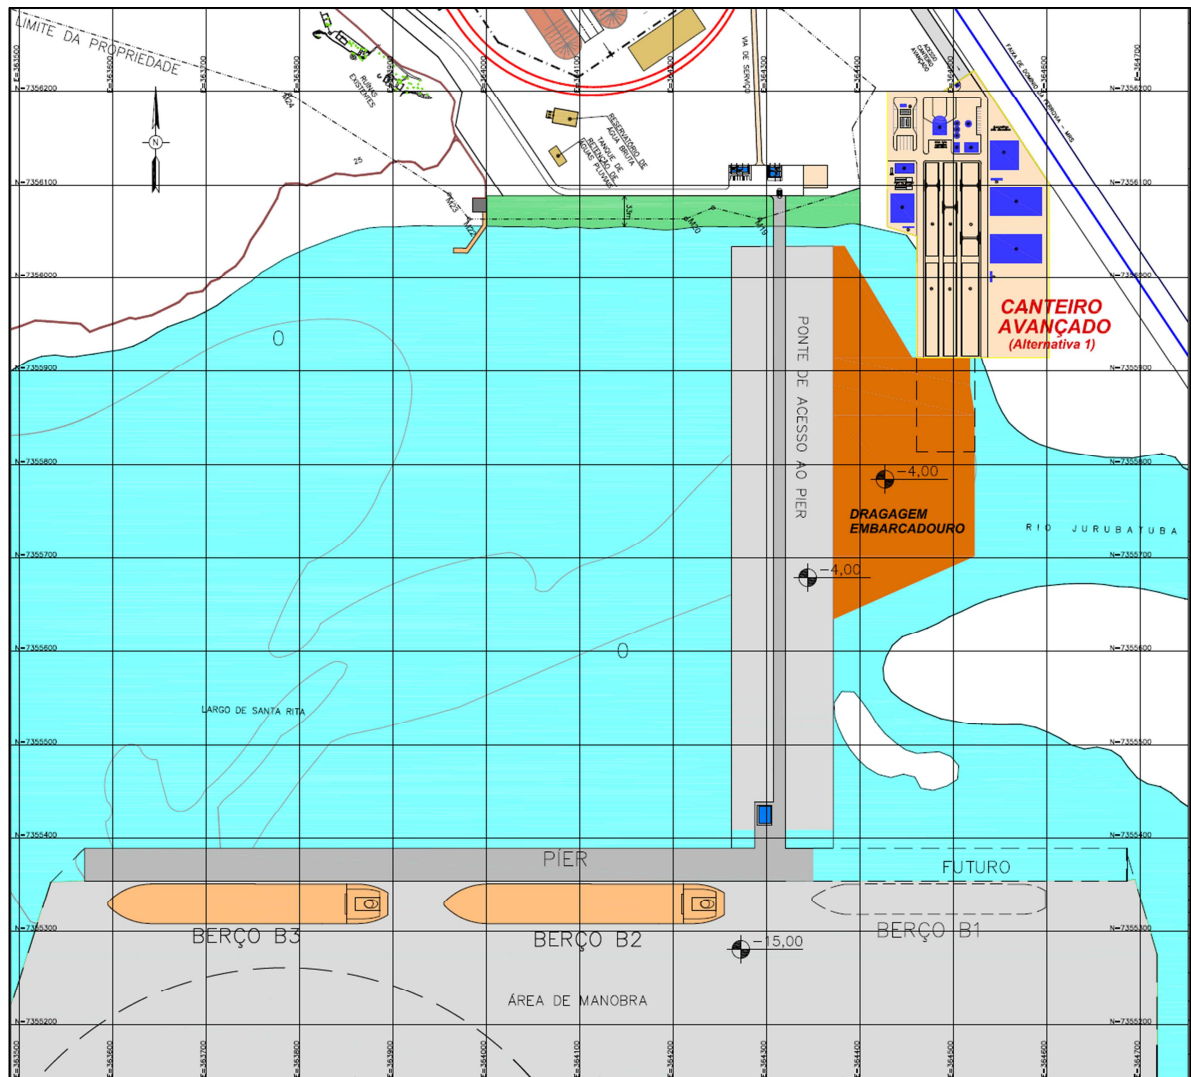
Projeto Conceitual de Dragagem – Canteiro Avançado – Alternativa 1 [8].
